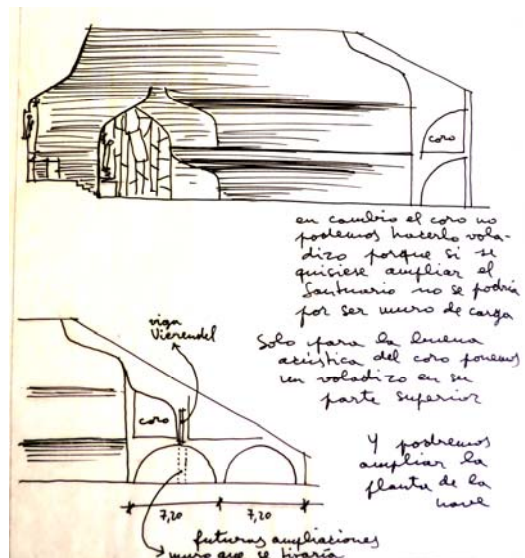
Croquis explicativo vidrieras laterales y viga cajón. Archivo de Heliodoro Dols Morell
